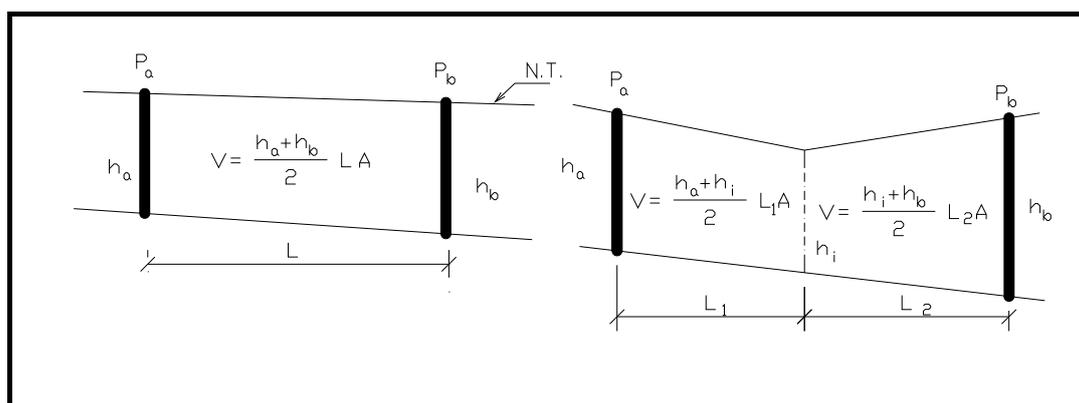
Seccion de zanja para el calculo del volumen de excavacion
